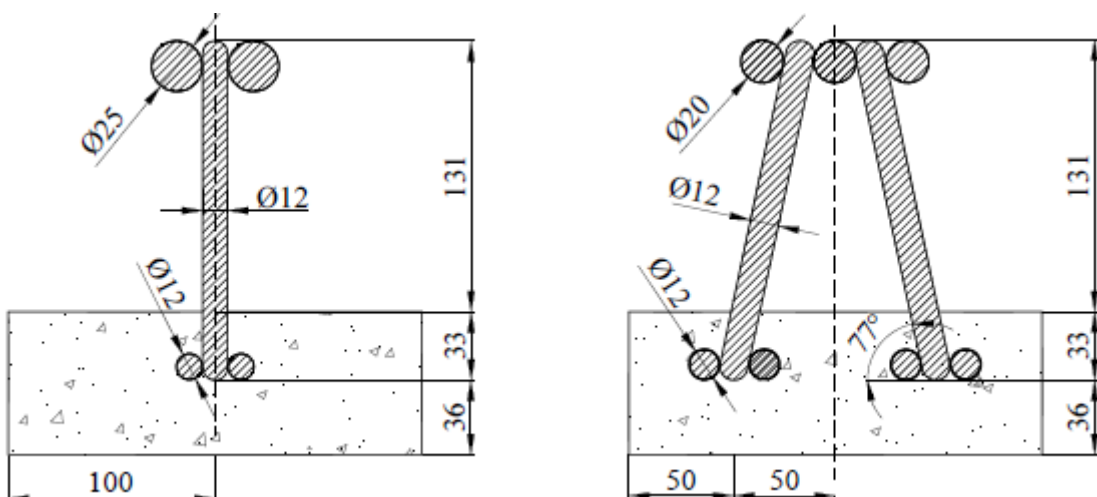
Secciones transversales fase SI, CSTCB Tipo B
